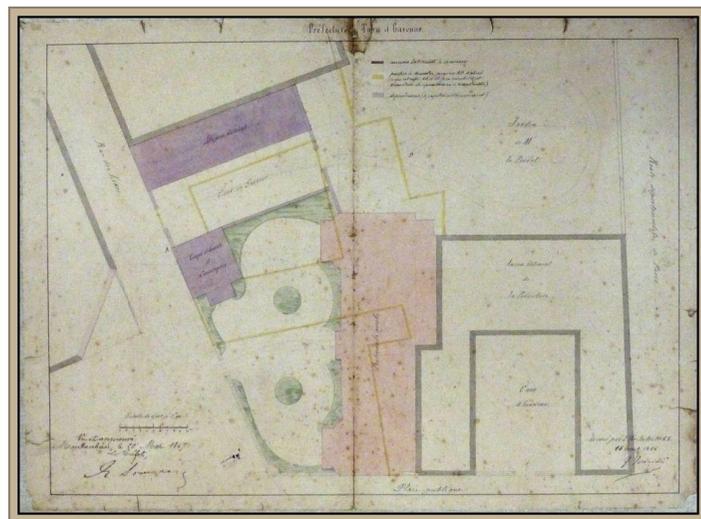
J. Bourdais, plan de masse, 15 août 1866
